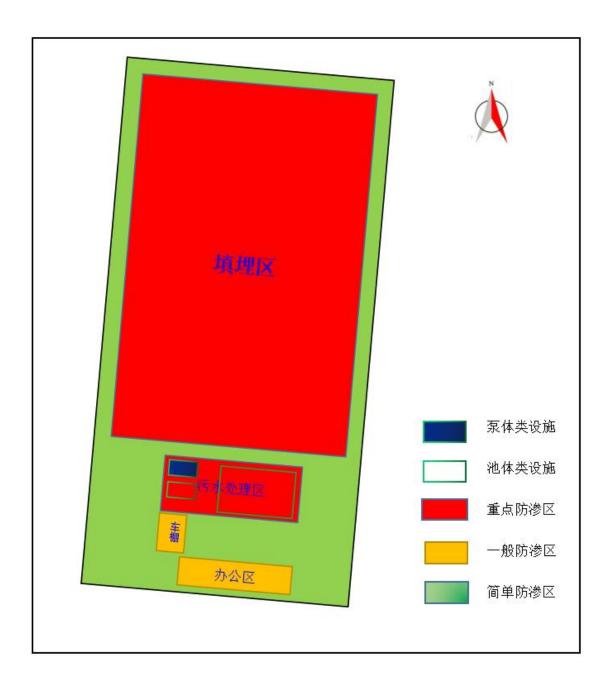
重点场所和重点设施防渗分区及平面布置图
